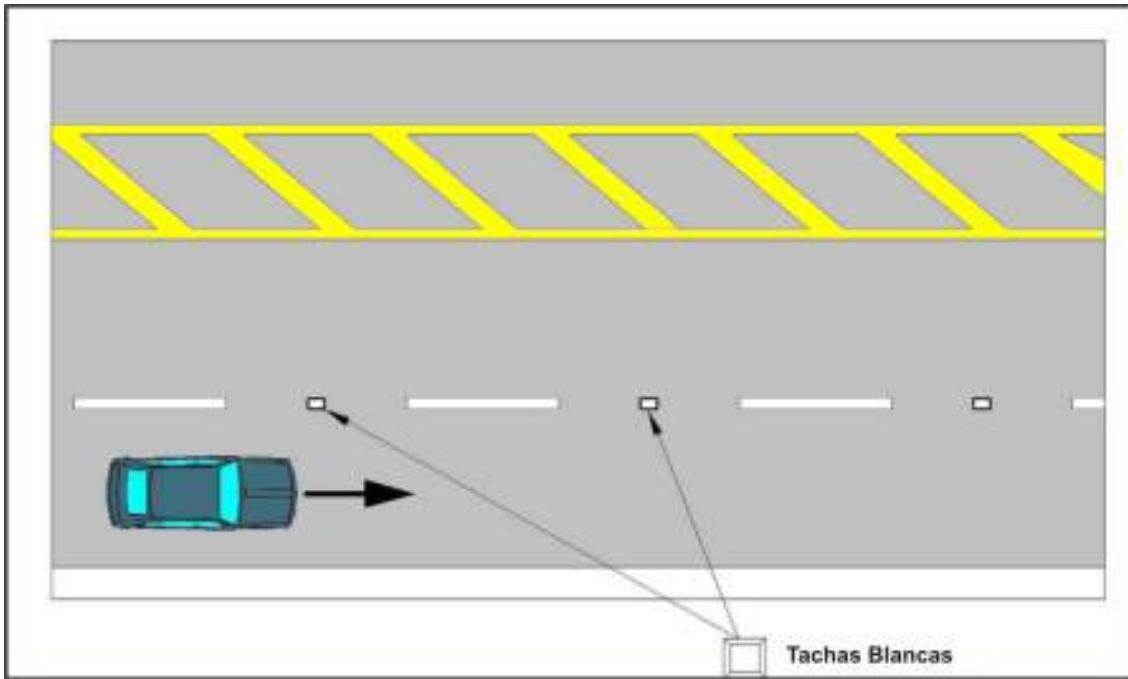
DEMARCACIÓN ELEVADA
